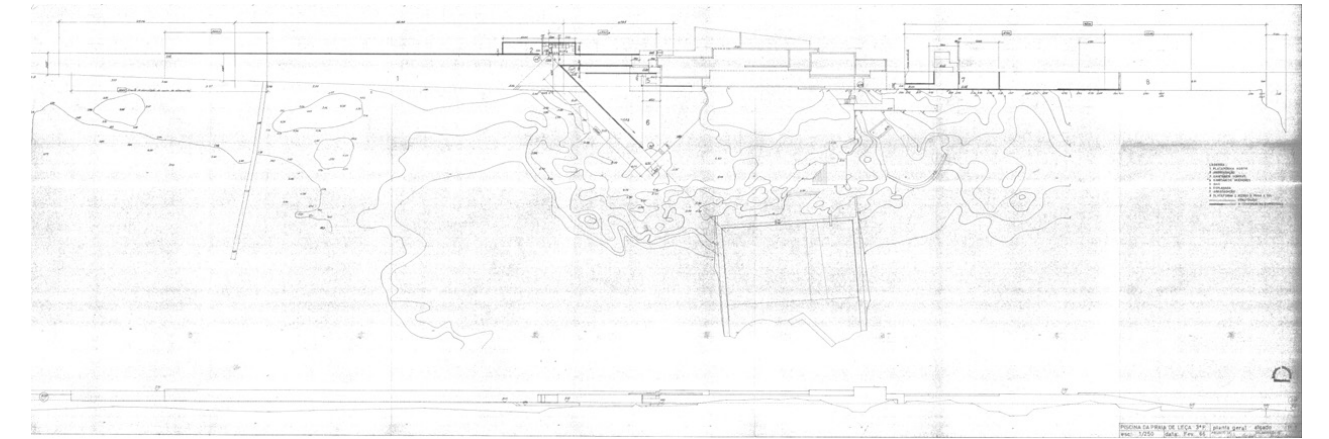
Planta geral e alçado da Piscina de Leça da Palmeira (1966) - Álvaro Siza Vieira
